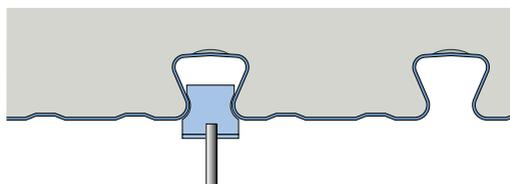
Accrochage de charge en sous-face de dalle avec un bac à nervures rentrantes
